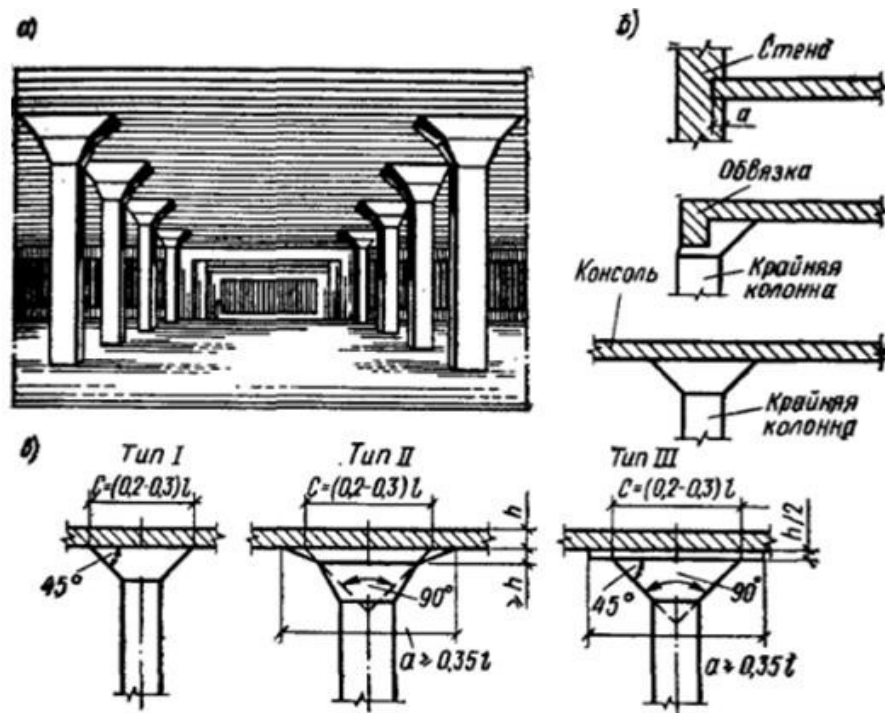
Конструкция безбалочного монолитного перекрытия
